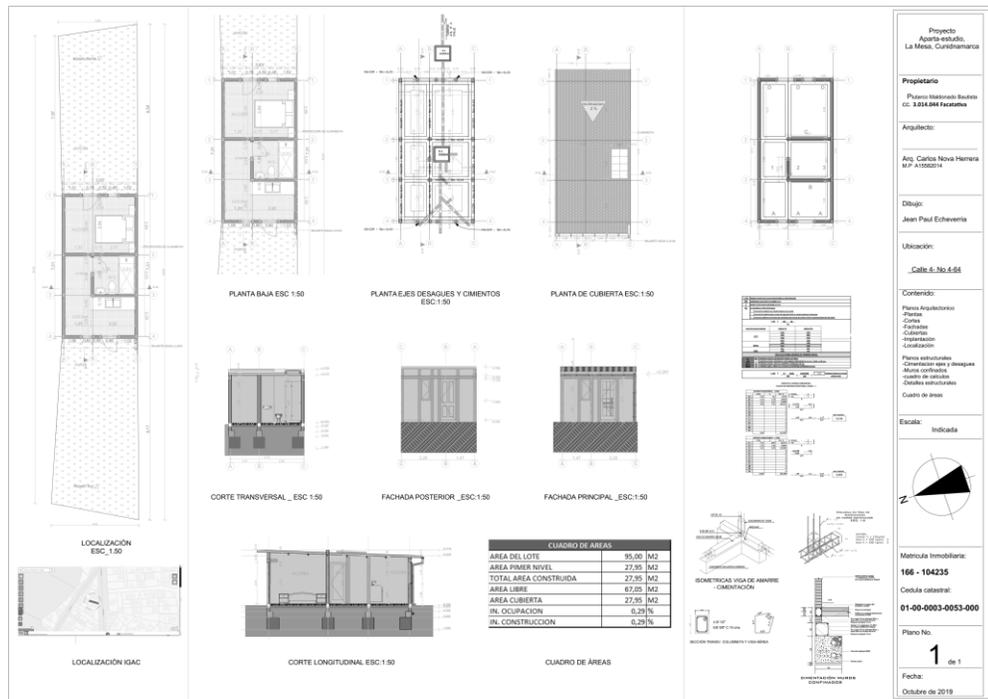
/ Casa mampostería estructural, Plutarco, fase de proyecto /propio
